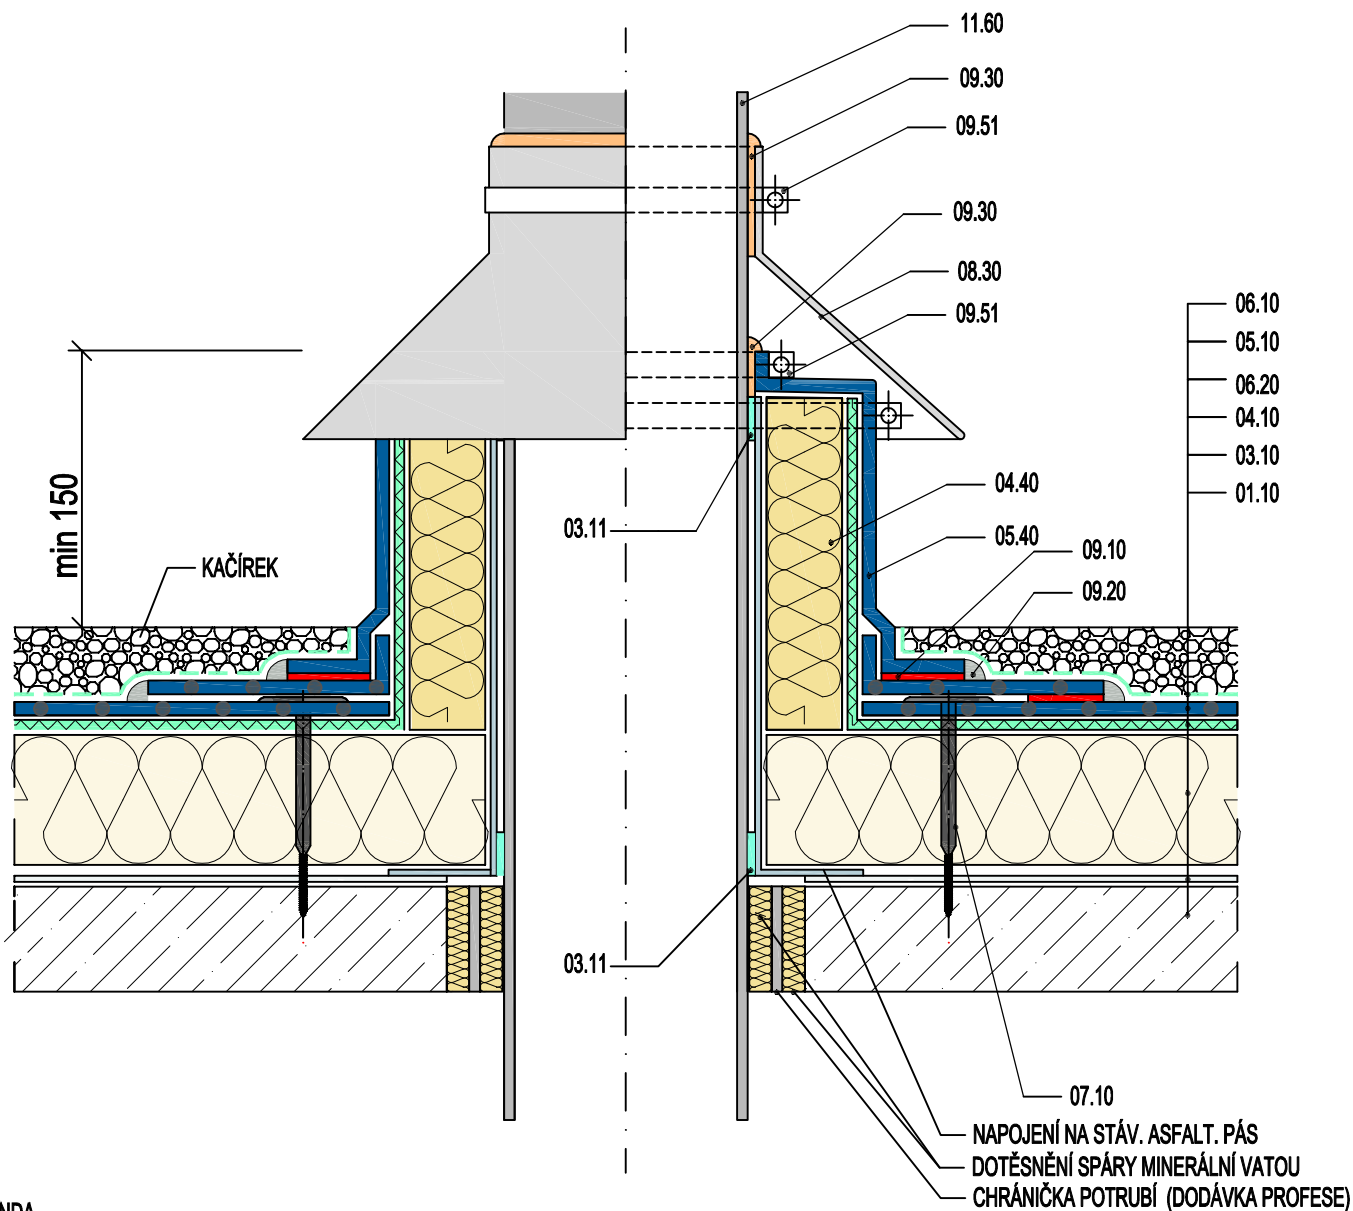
Detail prostupu kruhového izolovaného potrubí střechou - potrubí topení
